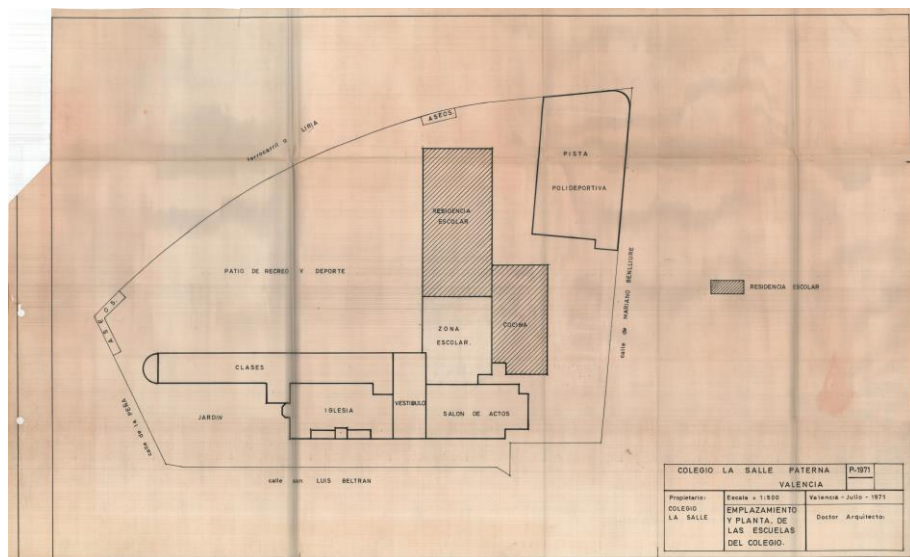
Emplazamiento y planta de las escuelas del Colegio La Salle
